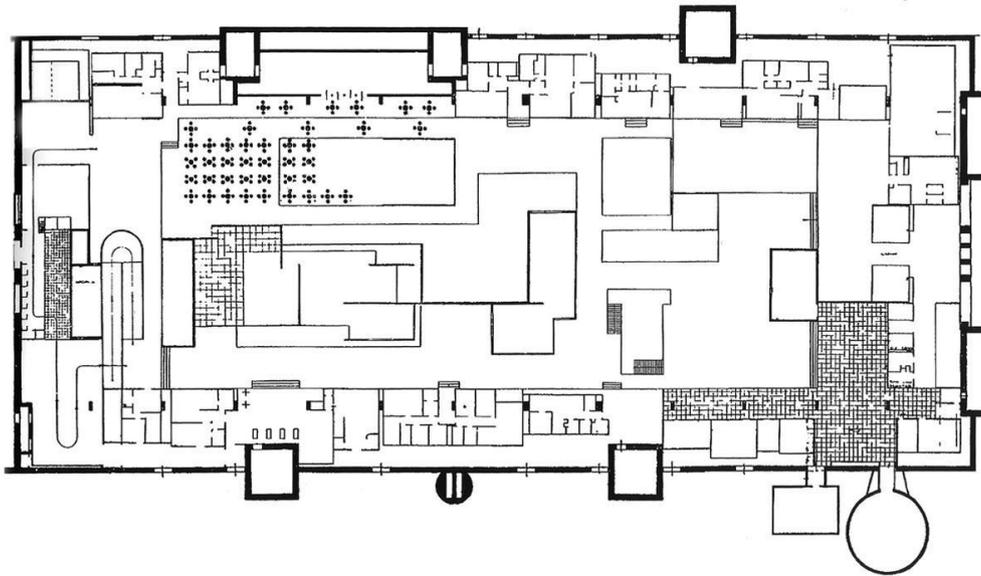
Planta geral da Exposição Arquitetura e Construção, Berlim, 1931
